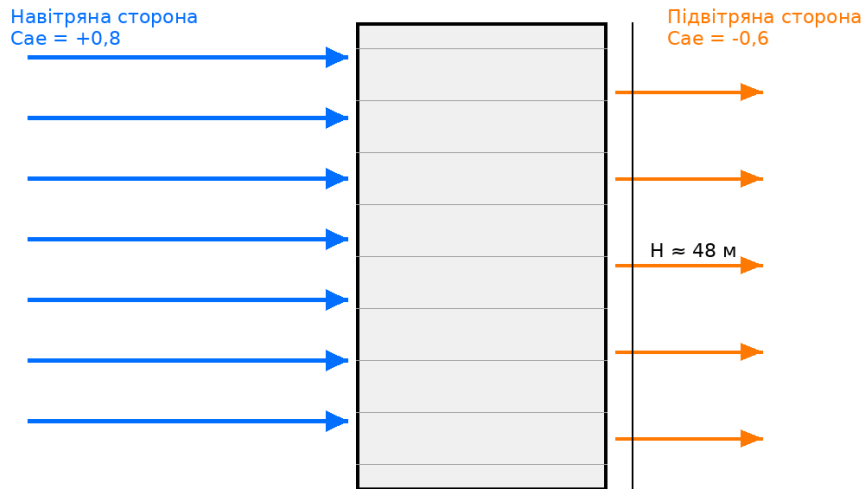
Схема прикладання вітрового навантаження до будівлі
